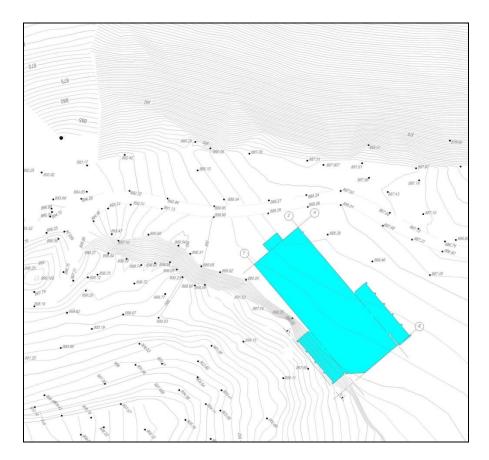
Фрагмент генерального плана размещения станции канатной дороги
